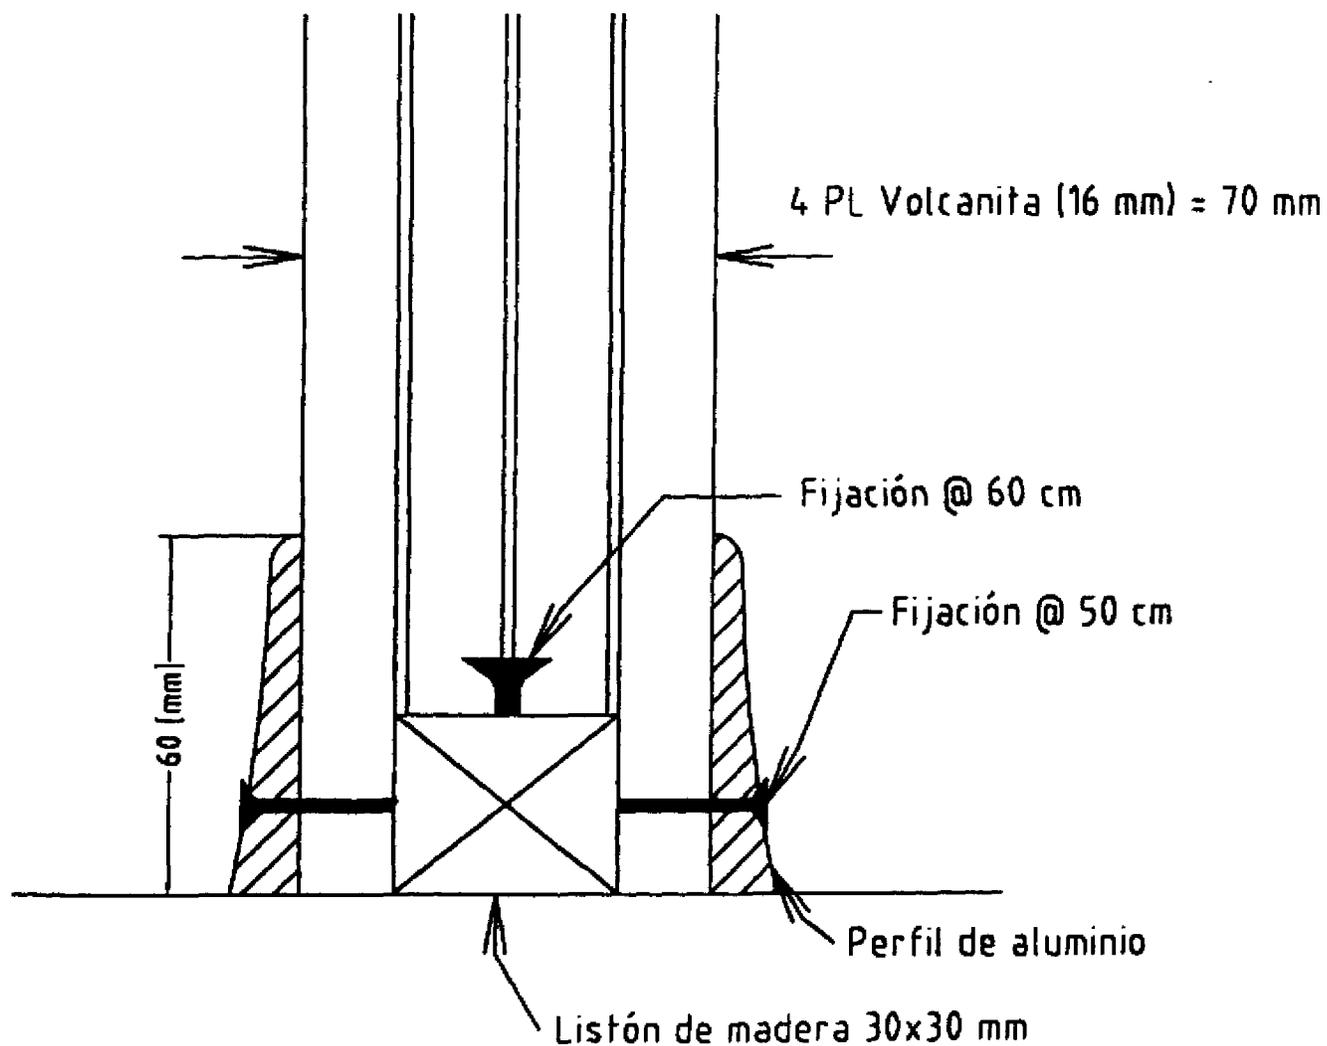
Detalle de apoyo inferior de la Tabiquería Tipo 2.
